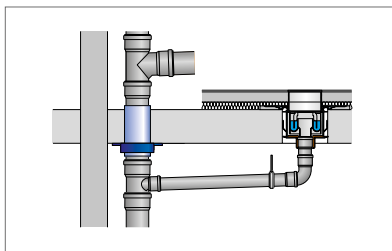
Viega Advantix R 120 Bodenablauf und Rohrdurchführung – brennbare Entwässerungsleitungen
